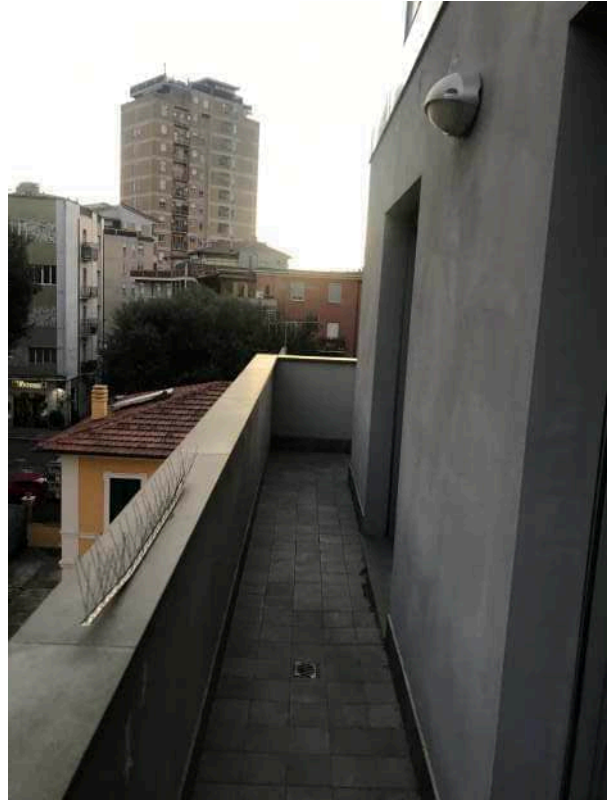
vista del terrazzo perimetrale l'unità immobiliare - segni di infiltrazioni sul prospetto in prossimità della camera matrim. e camera 1 proveniente dalla loggia/parapetto dell'unità imm. soprastante (p.5°) .
